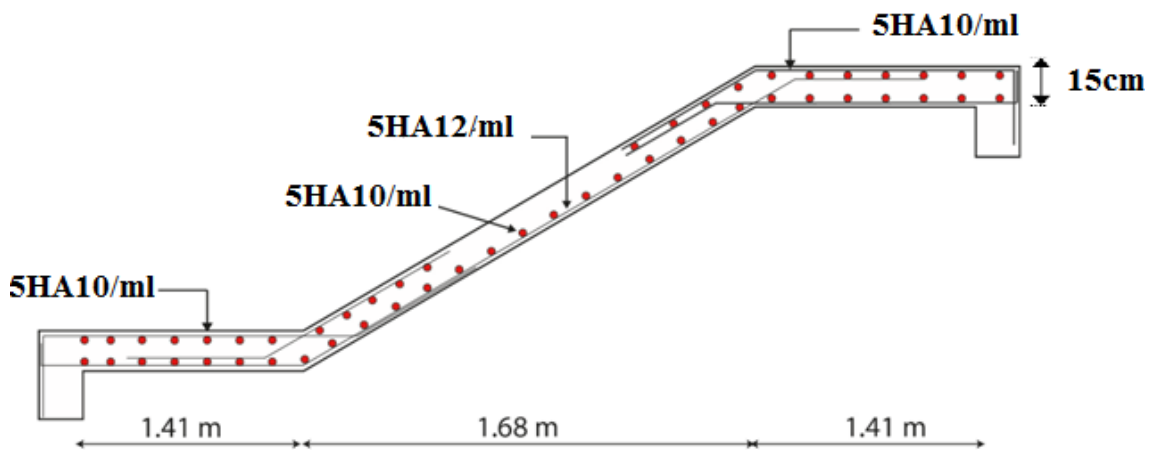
Schéma de ferrailage de la partie 1 de l'escalier.
